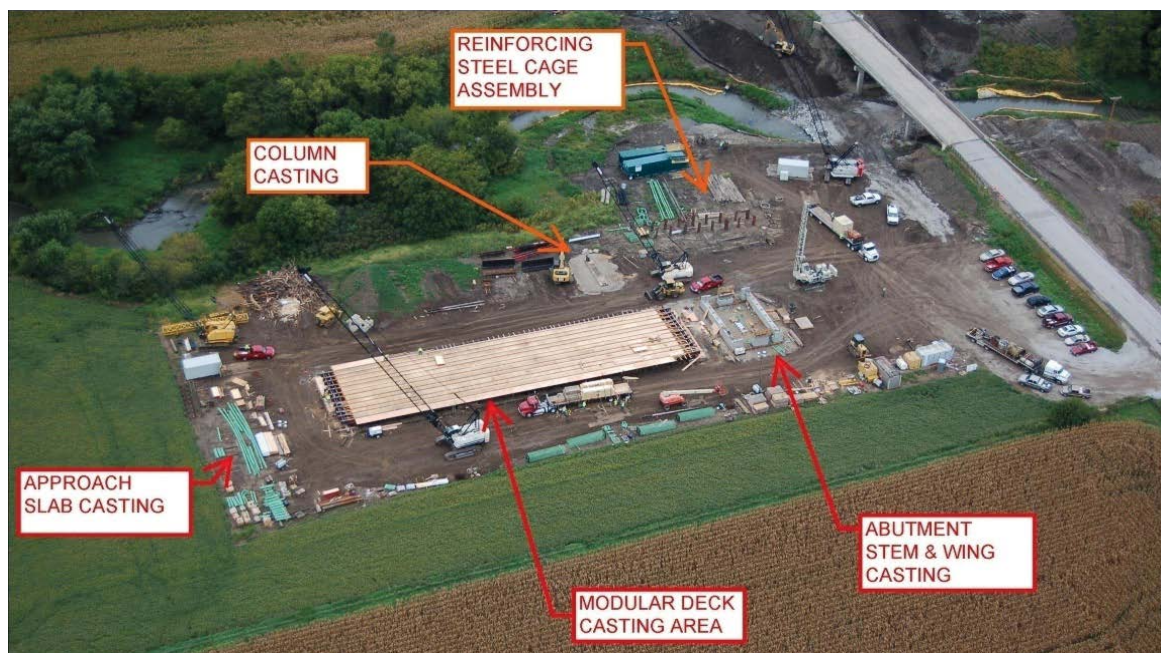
現場プレキャスト化の施工ヤード¹⁵⁾
